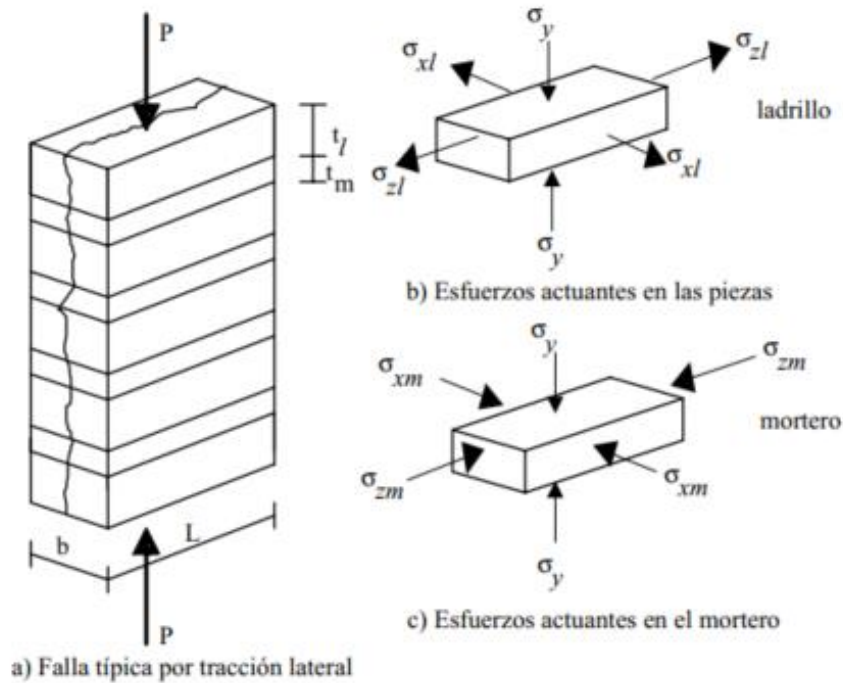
Mecanismo de falla de mampostería por compresión (Tena, 2001).
